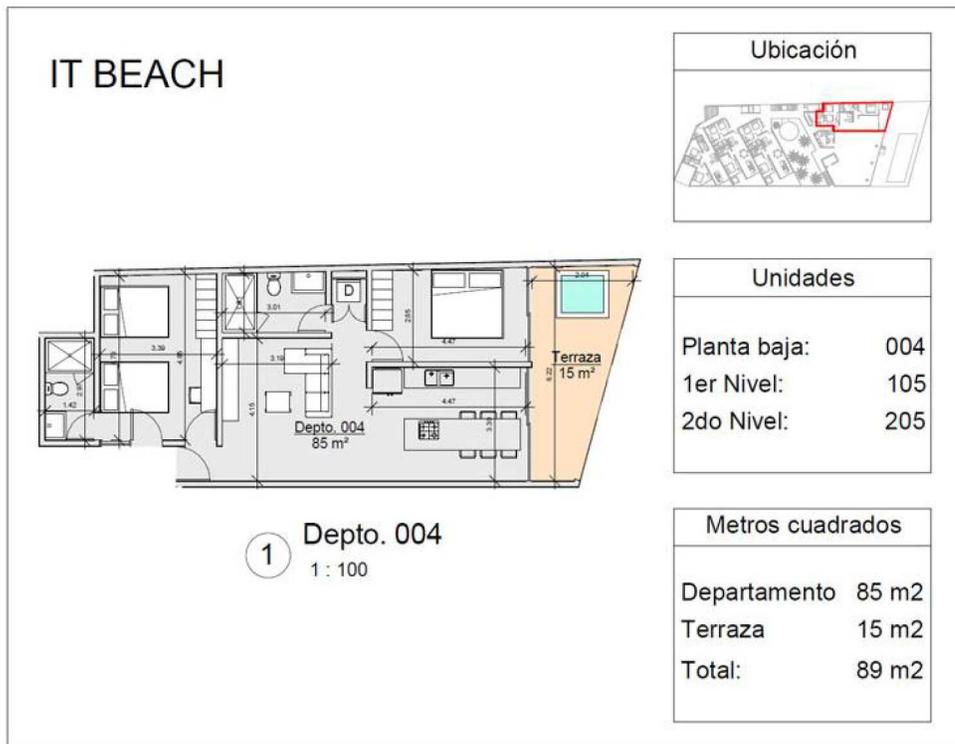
Distribución de los componentes de los departamentos con vista a la Calle Pelicano en planta baja, primer nivel, segundo y tercer nivel.
